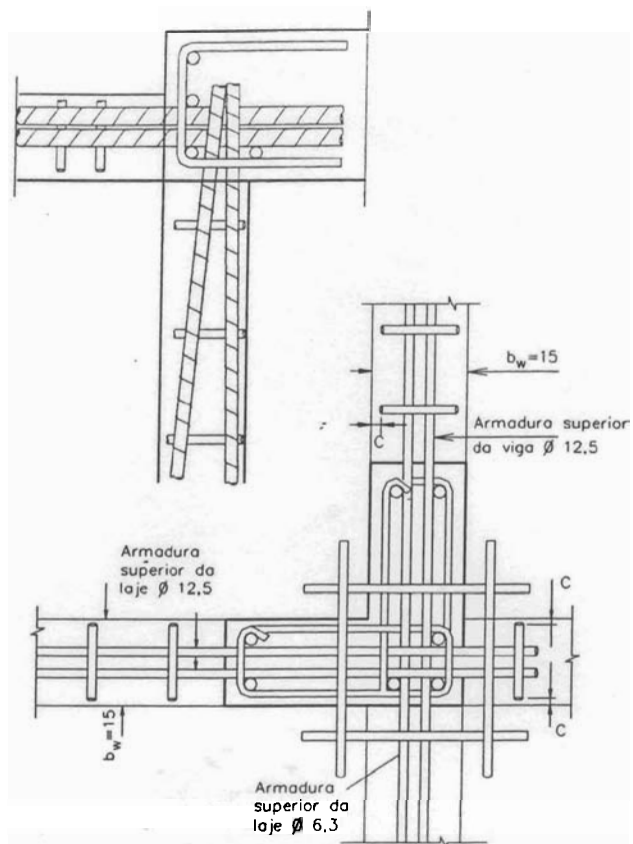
Congestionamento inaceitável entre armaduras de vigas e pilares [FUSCO, 1994]
